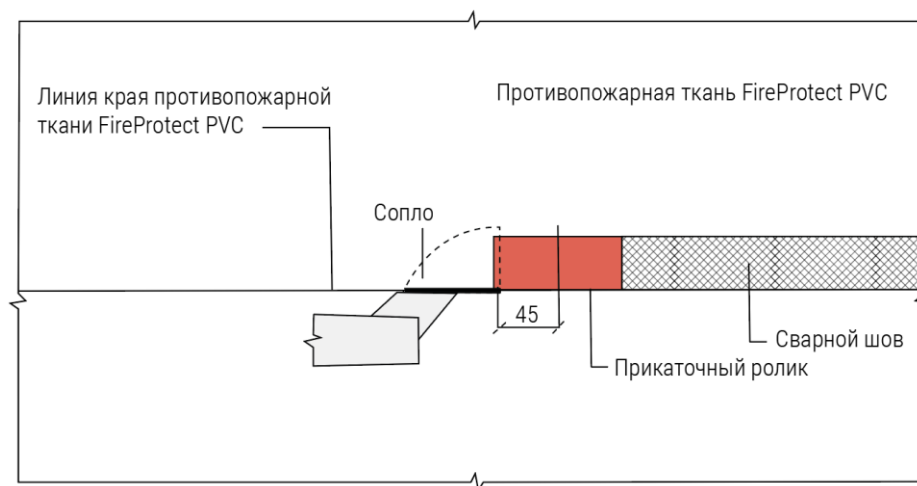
Расположение прикаточного ролика и сопла у автоматического сварочного оборудования
